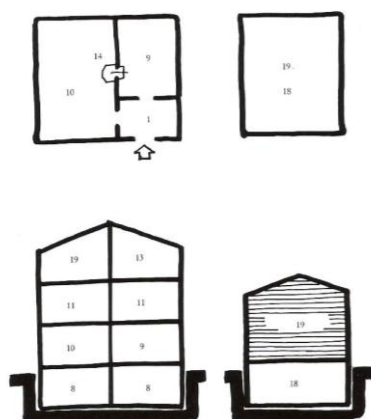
Pianta e sezioni di un edificio tipo del Terziere Superiore
